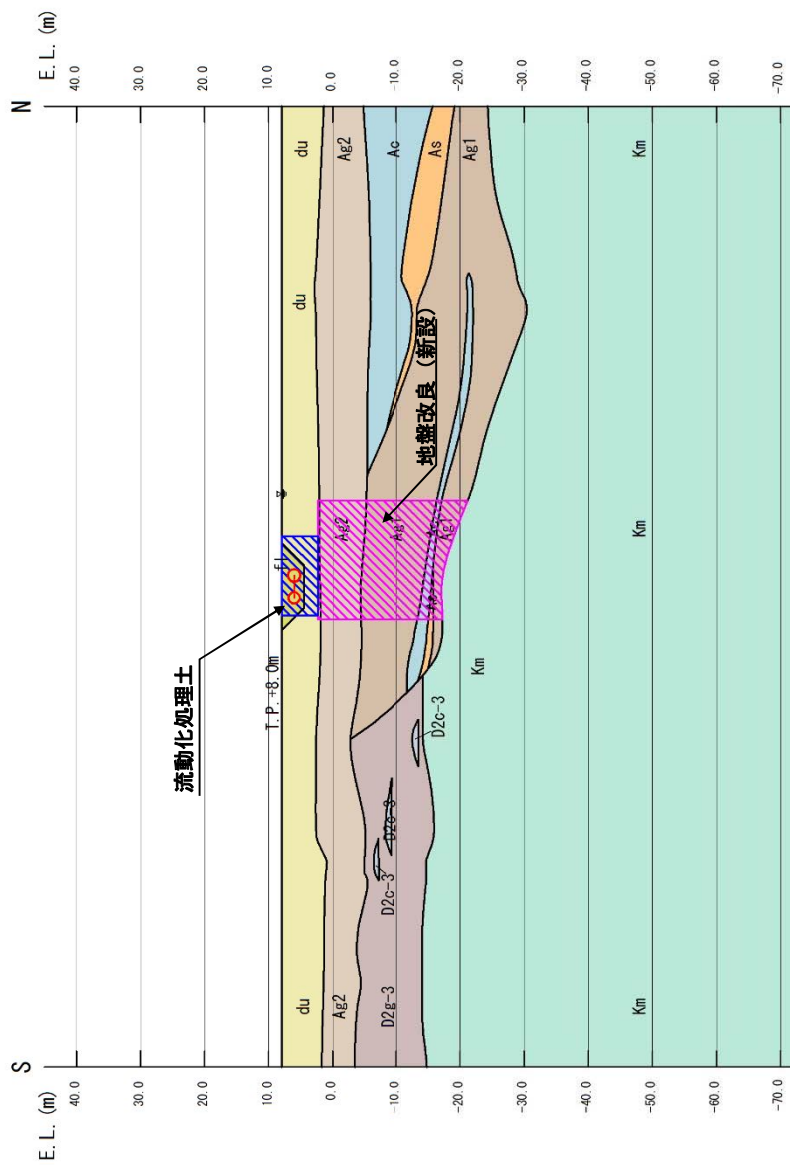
(4) 屋外二重管の横断面図 (C-C断面・地盤改良部) (区間Ⅲ 断面⑥)
